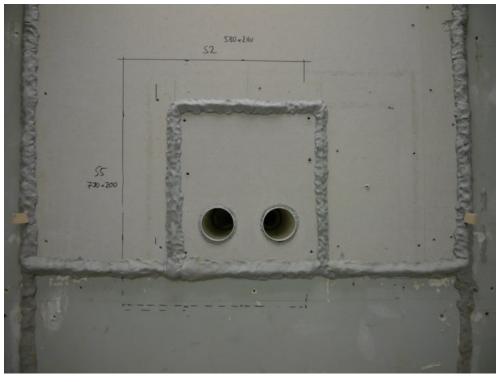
Lüftungsöffnungen außenseitig (Fortluft links, Außenluft rechts), Fassadenabschluss Edelstahlschote noch nicht montiert.
